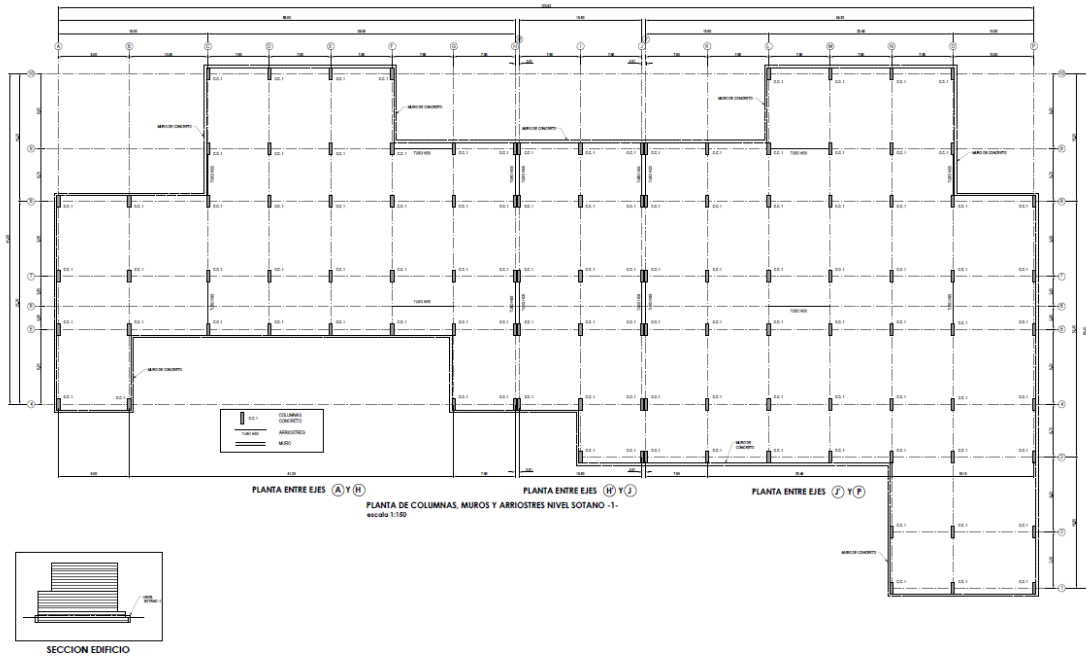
Planta Estructural Columnas, Muros y Arriostres. Sótano 1
